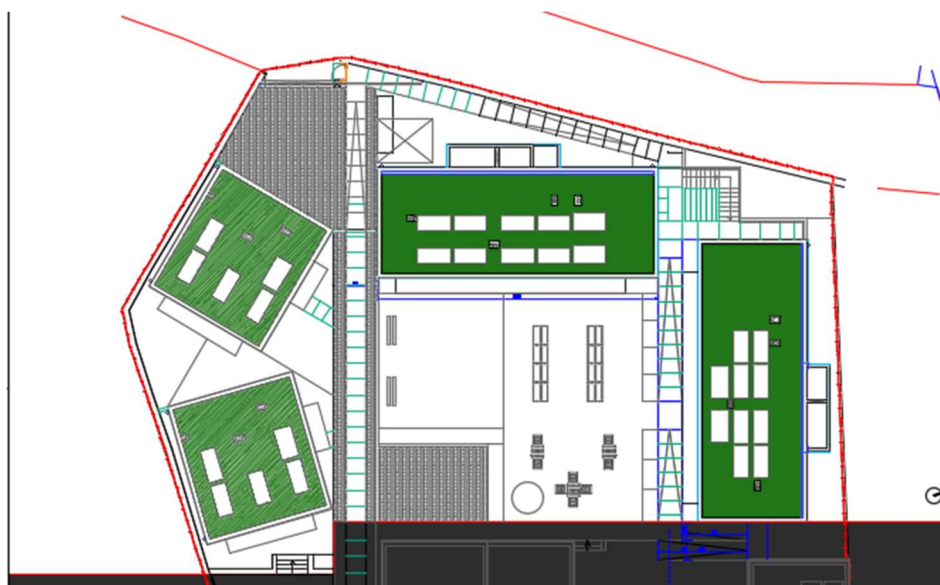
Planta de Implantação RAI (Eleven Steps, 2023)
